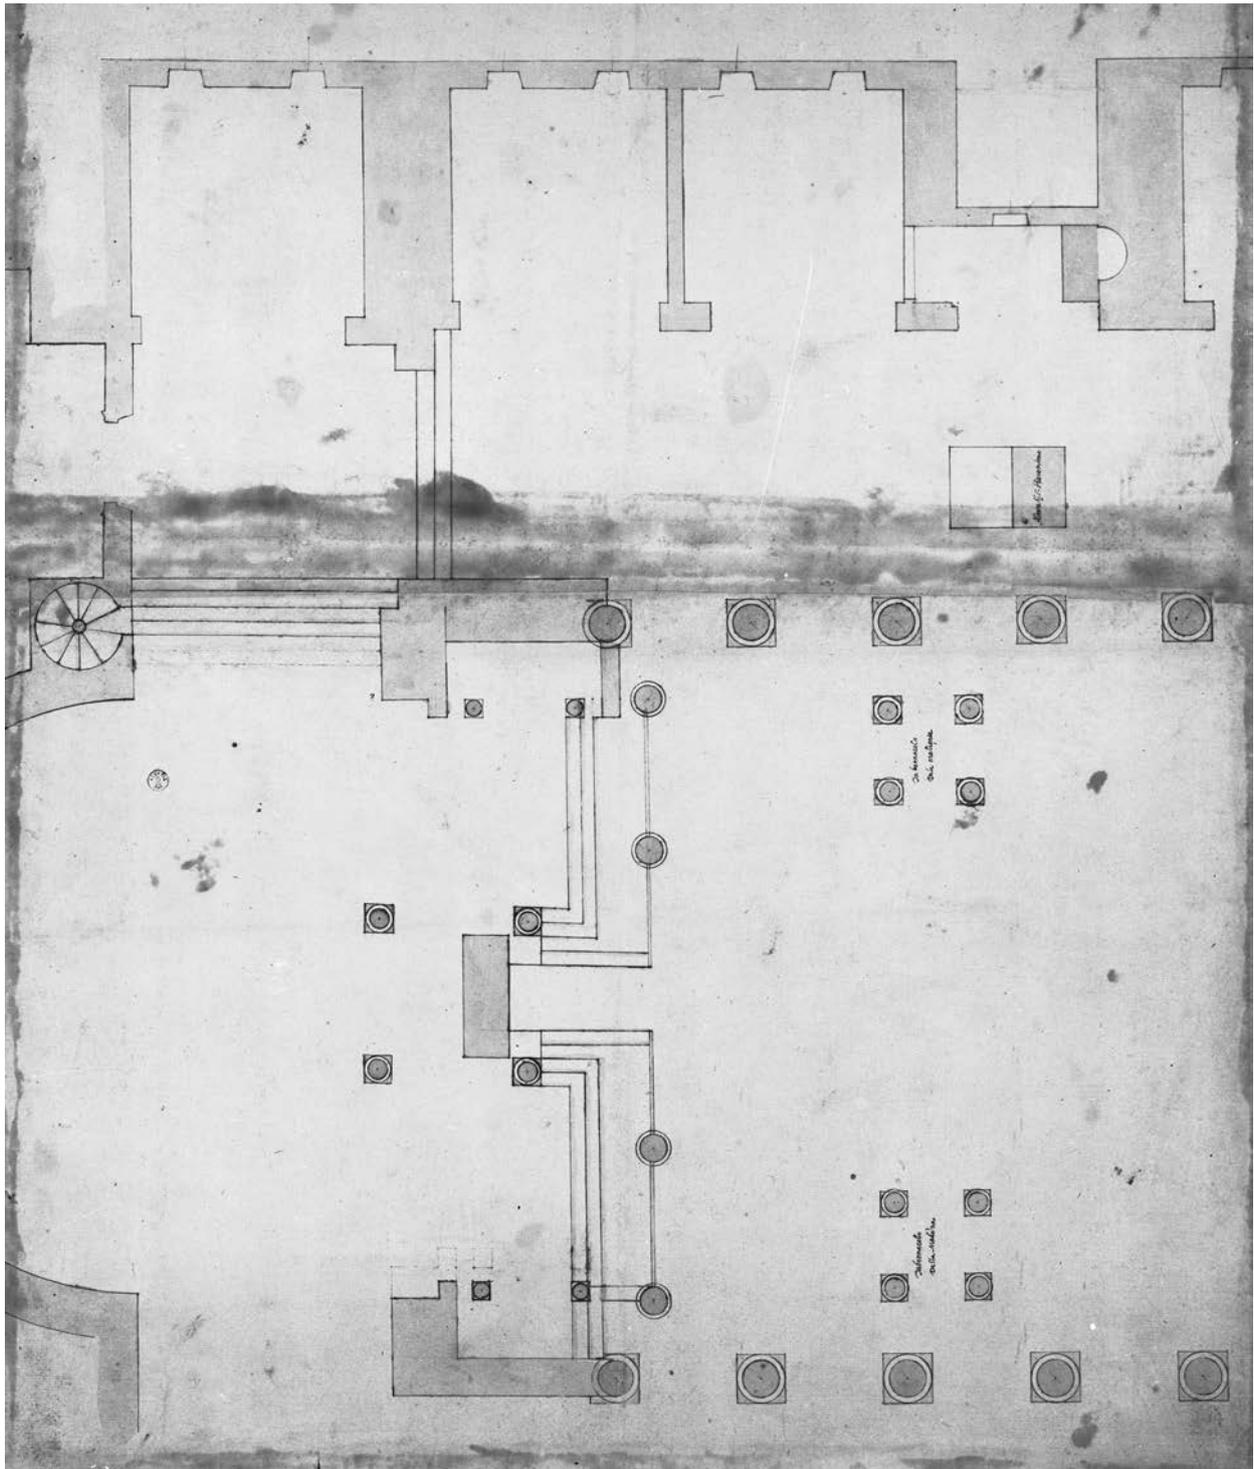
Rom, S. Maria Maggiore, Grundriss, B. de Rocchi, vor 1573. Florenz, Uffizien, dis. Arch. 4216
